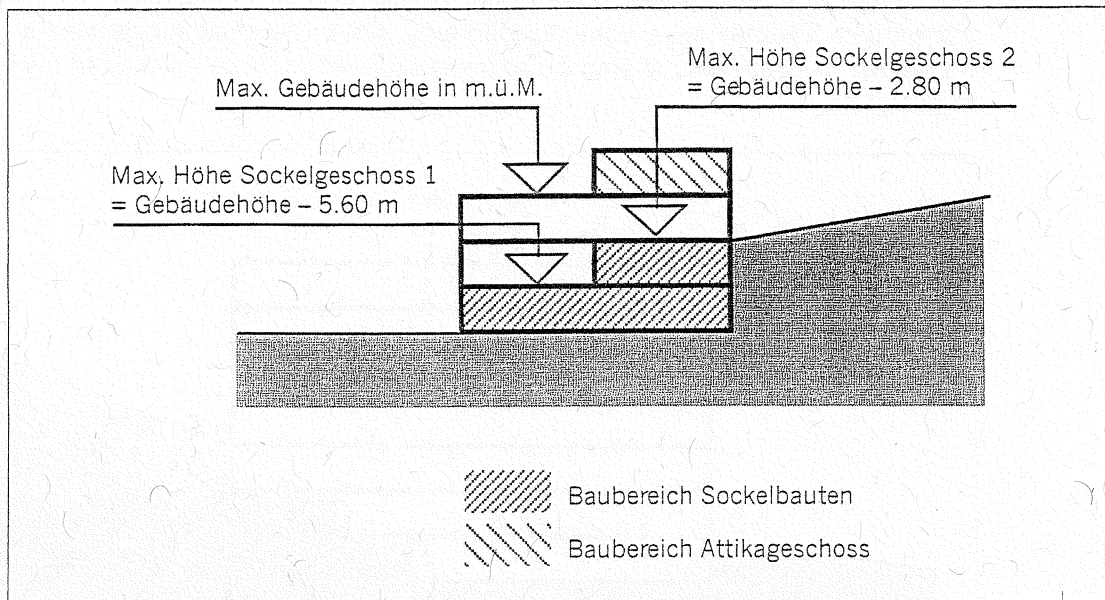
Schema-Querschnitt Hauptbauten mit Baubereichen Sockelbauten und Attikageschoss
